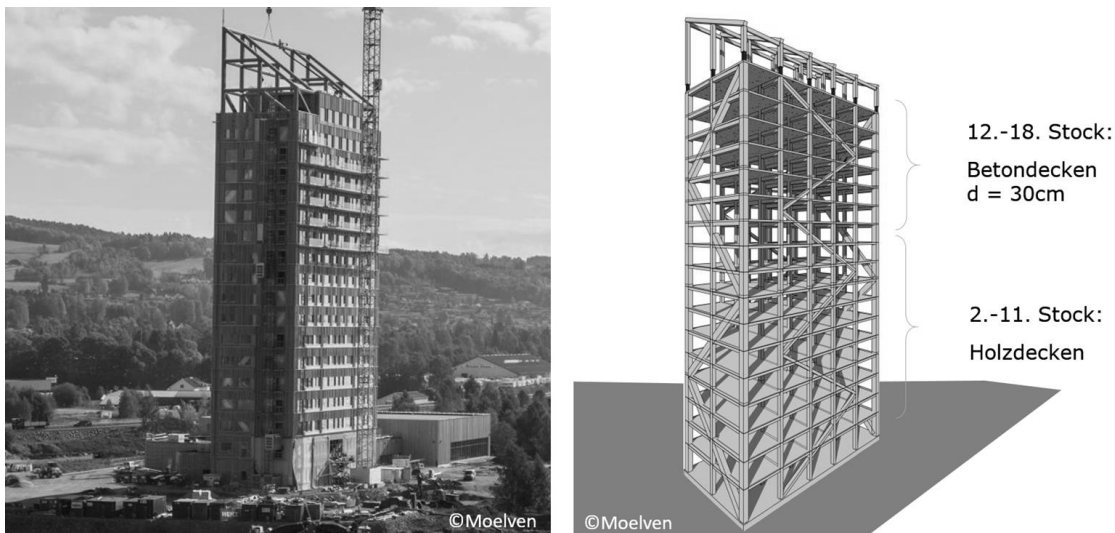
Konstruktion 18 stöckiger Mjøstårnet, Norwegen. Holzdecken unten und Betondecken oben
